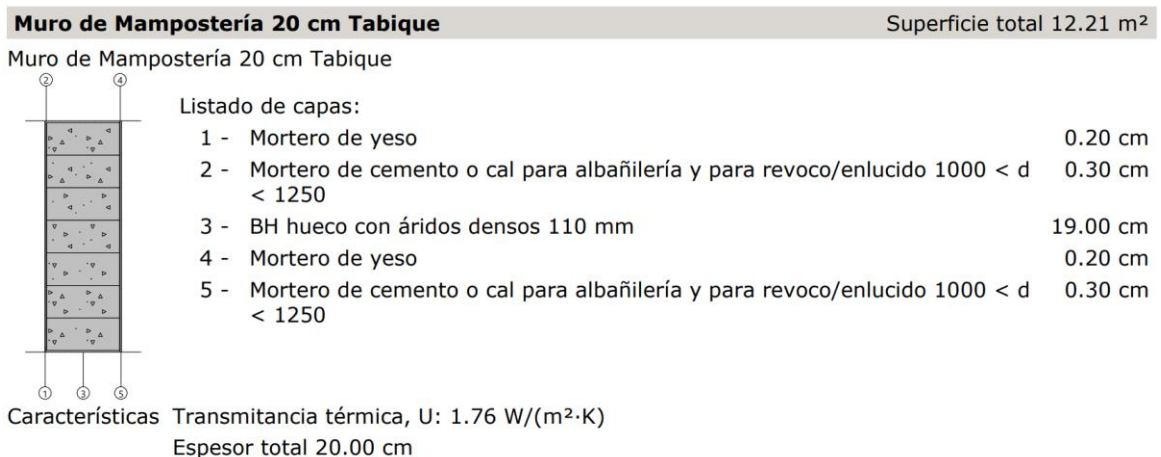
Vista de sección y transmitancia térmica de los muros de mampostería de 0.20 metros de espesor de tabiquería
